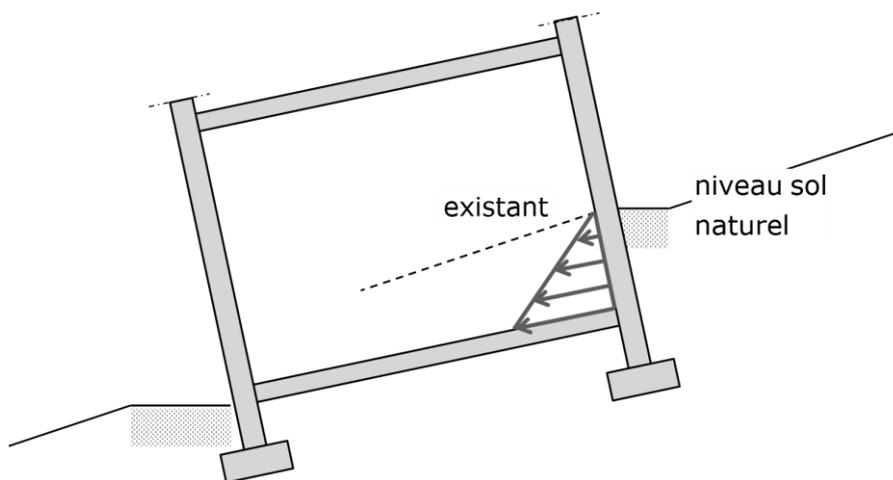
exemple de la présence d'un mur de clôture rattaché à la structure principale
